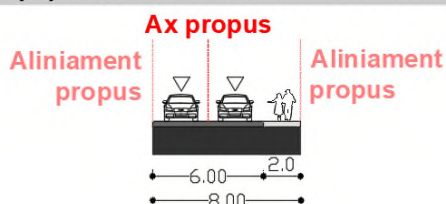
Profile stradale strada Chilie, strada Panait Cerna și strada Soveja;
